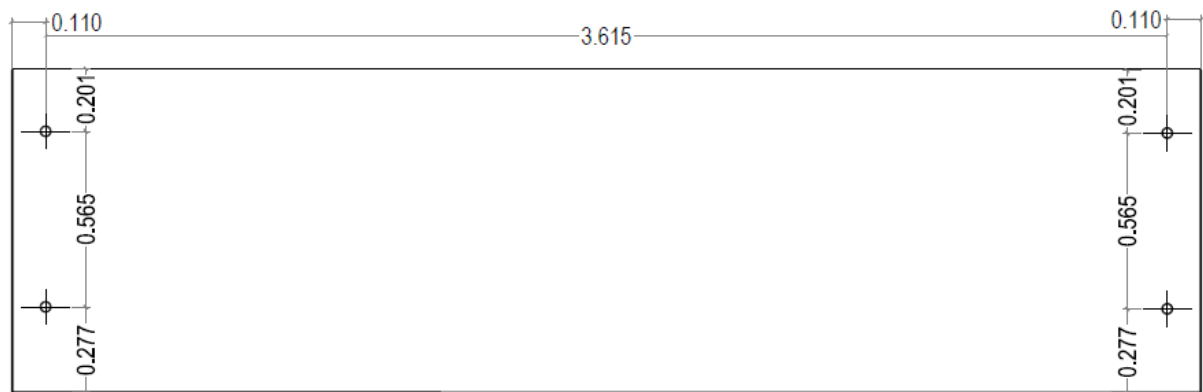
Planta do painel. Localização das ligações aparafusadas (dimensões em m)
